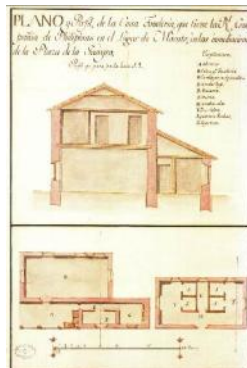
Planta y sección de la tonelería de Macuto (Vivas Pineda, 1998, p. 251).
